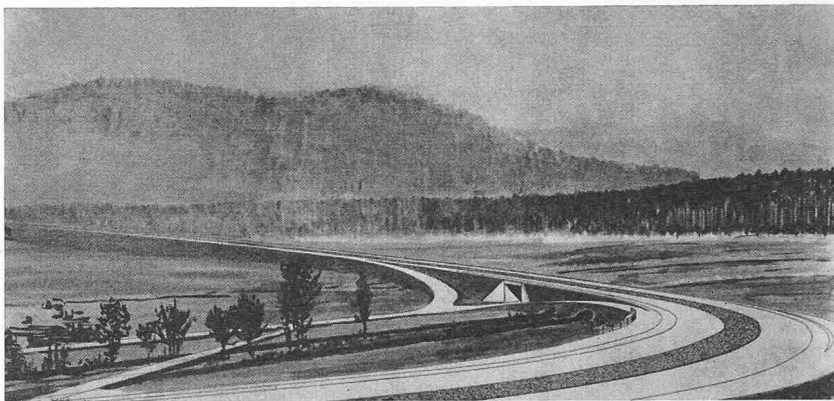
Photomontage der westlichsten Teilstrecke der Dättnauer-Variante mit dem Anschlusswerk. Nach links der Anstieg ins Dättnauer Tal
